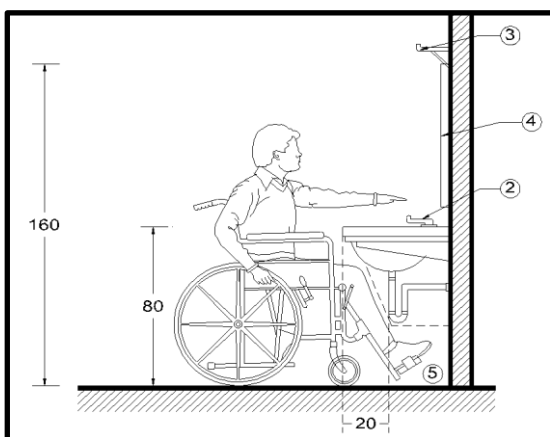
Planta lavabo en baños, Conadis-accesibilidad, Monterrey, 2012
